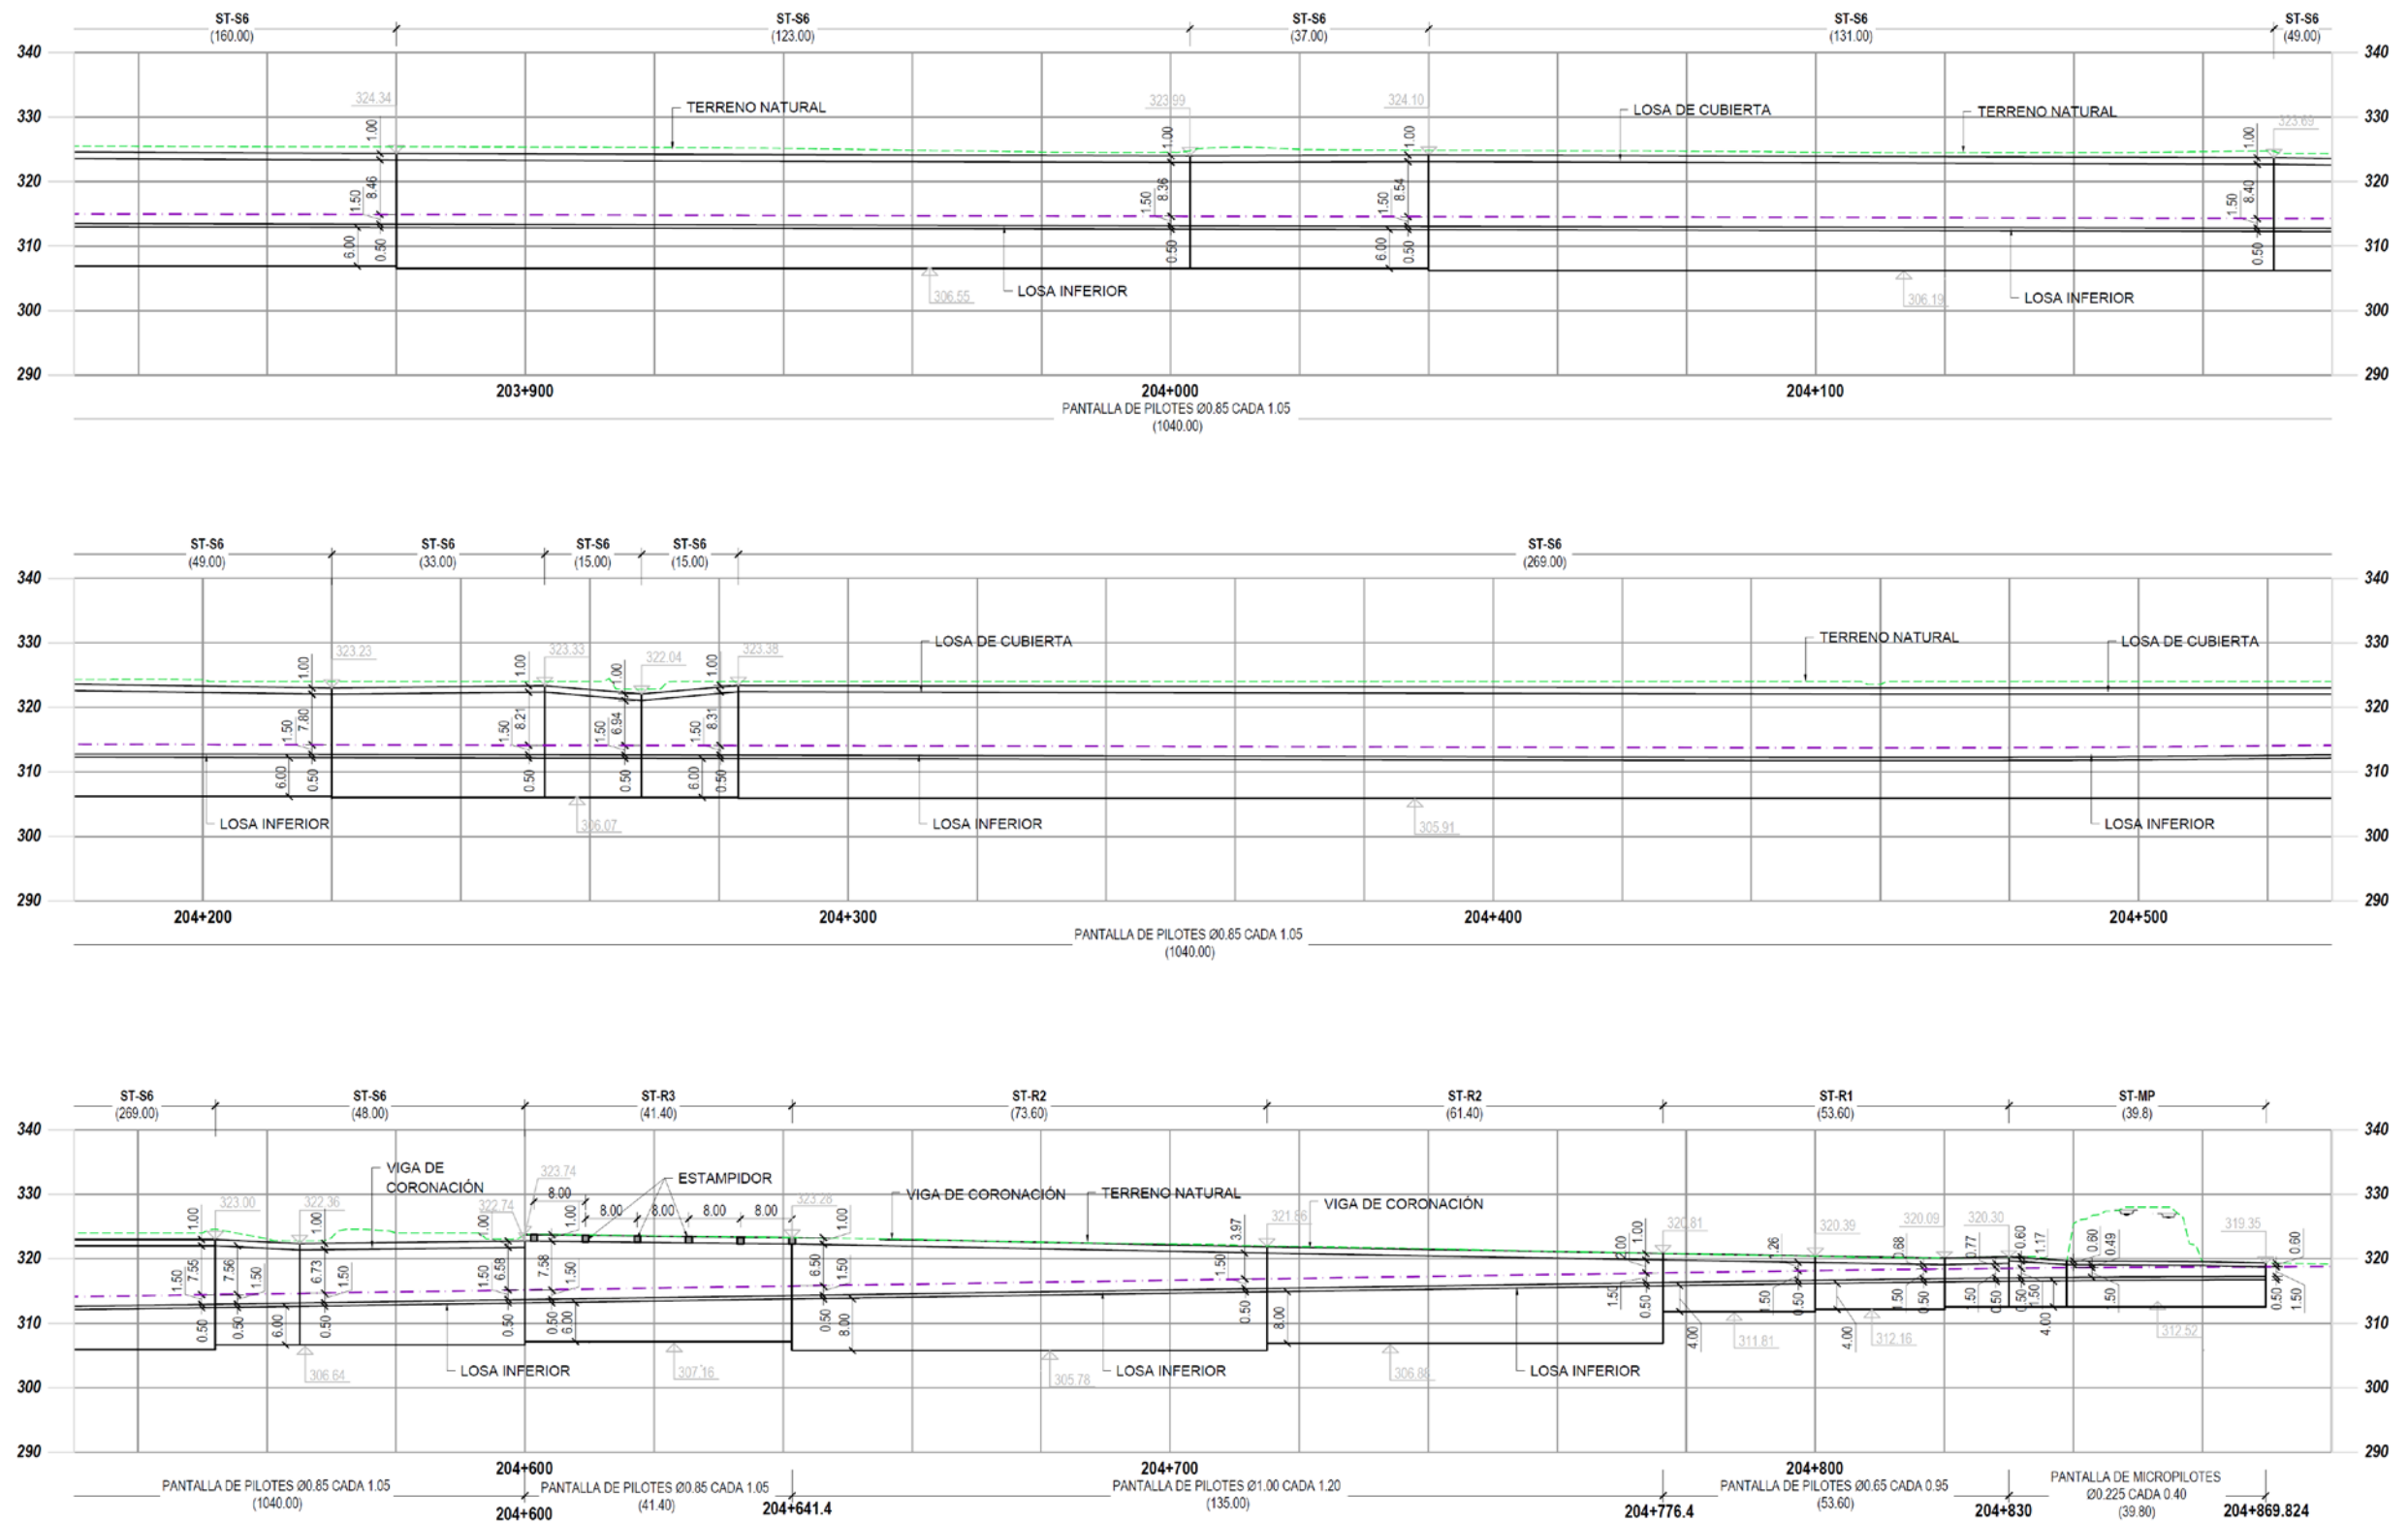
a.- Perfil longitudinal del tramo soterrado con indicación de las distintas soluciones constructivas (3 de 3).
